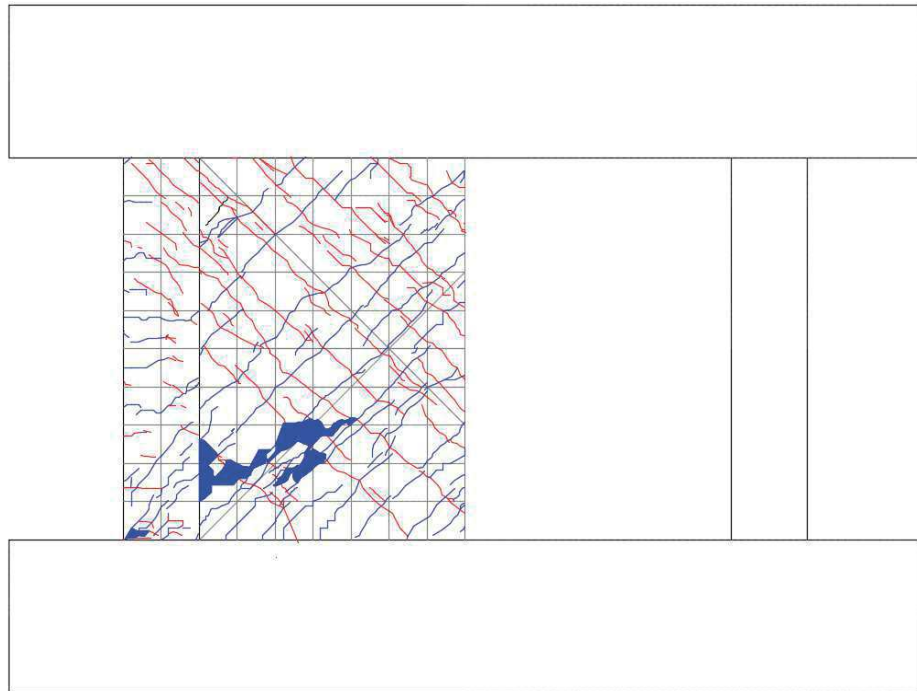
試験体 S-06-DIII 最終破壊時ひび割れ図
